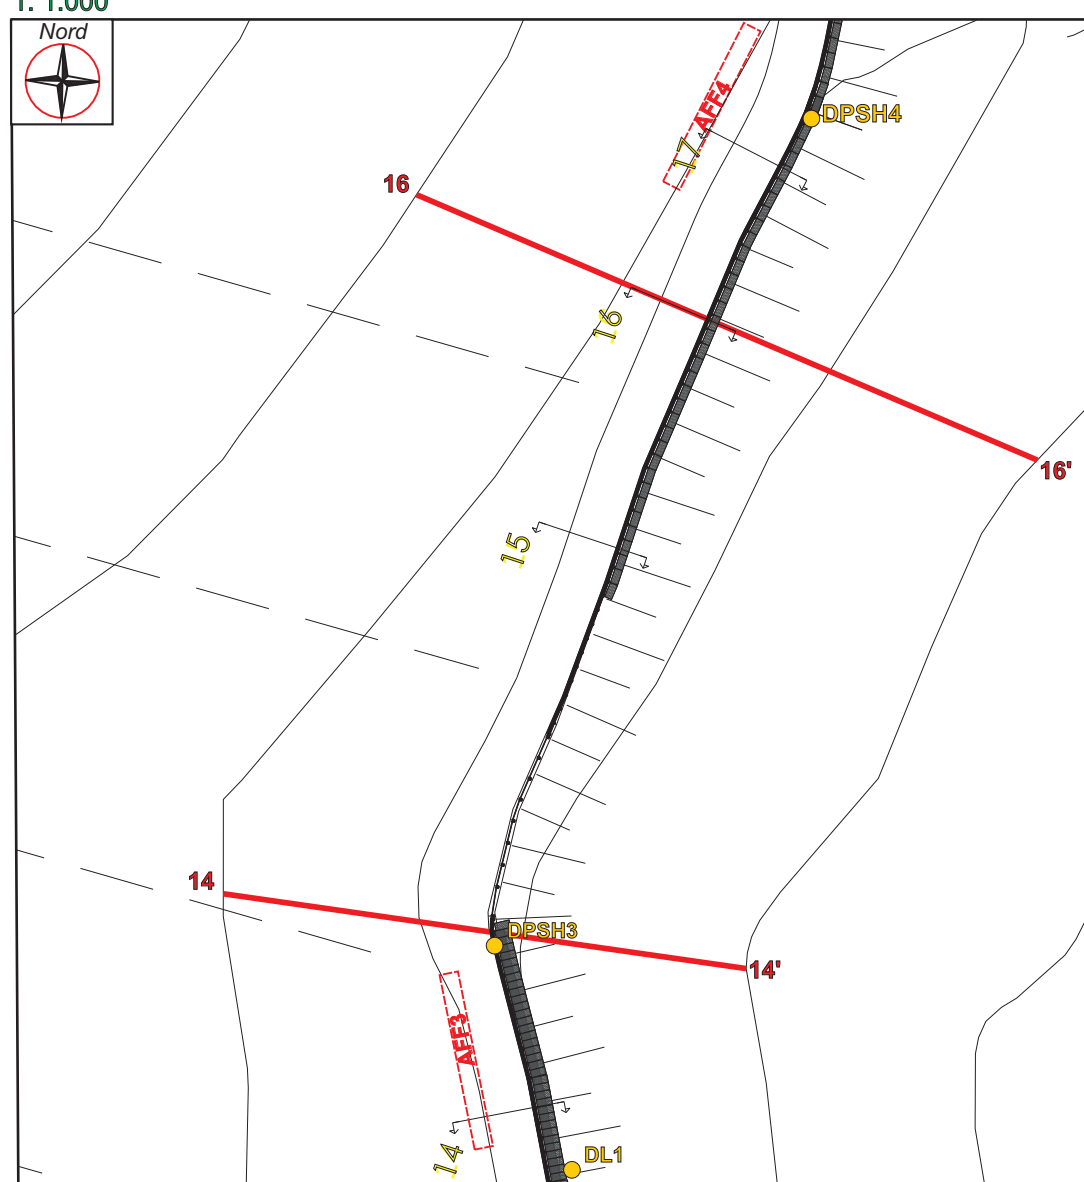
Planimetria del tracciato stradale compreso fra la Sez. 14-14' e Sez. 17-17', in scala 1: 1.000
